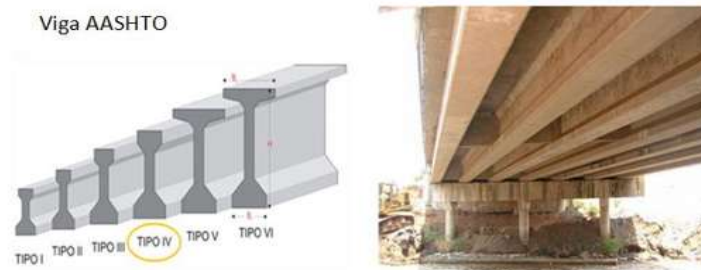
Puente ubicado en la carretera Maravatio-Atlacomulco (López, 2011).
